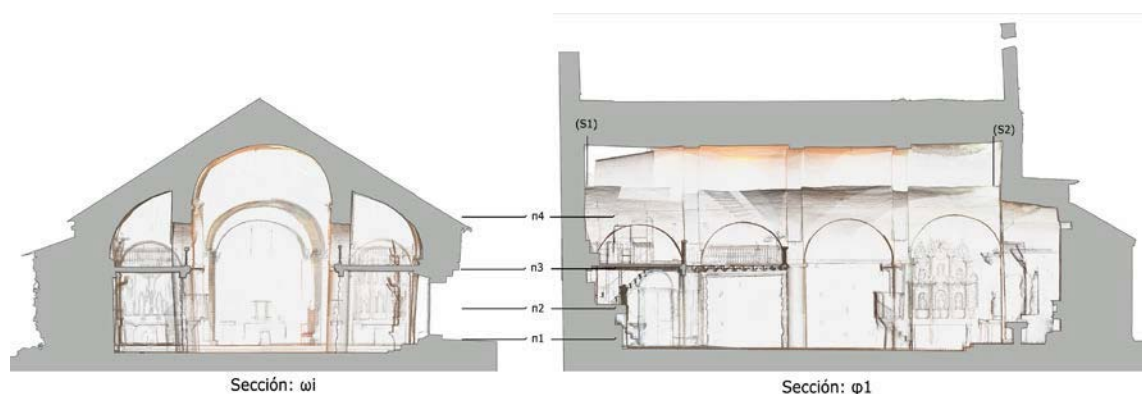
Sección transversal y longitudinal de Santa María d'Arties.
